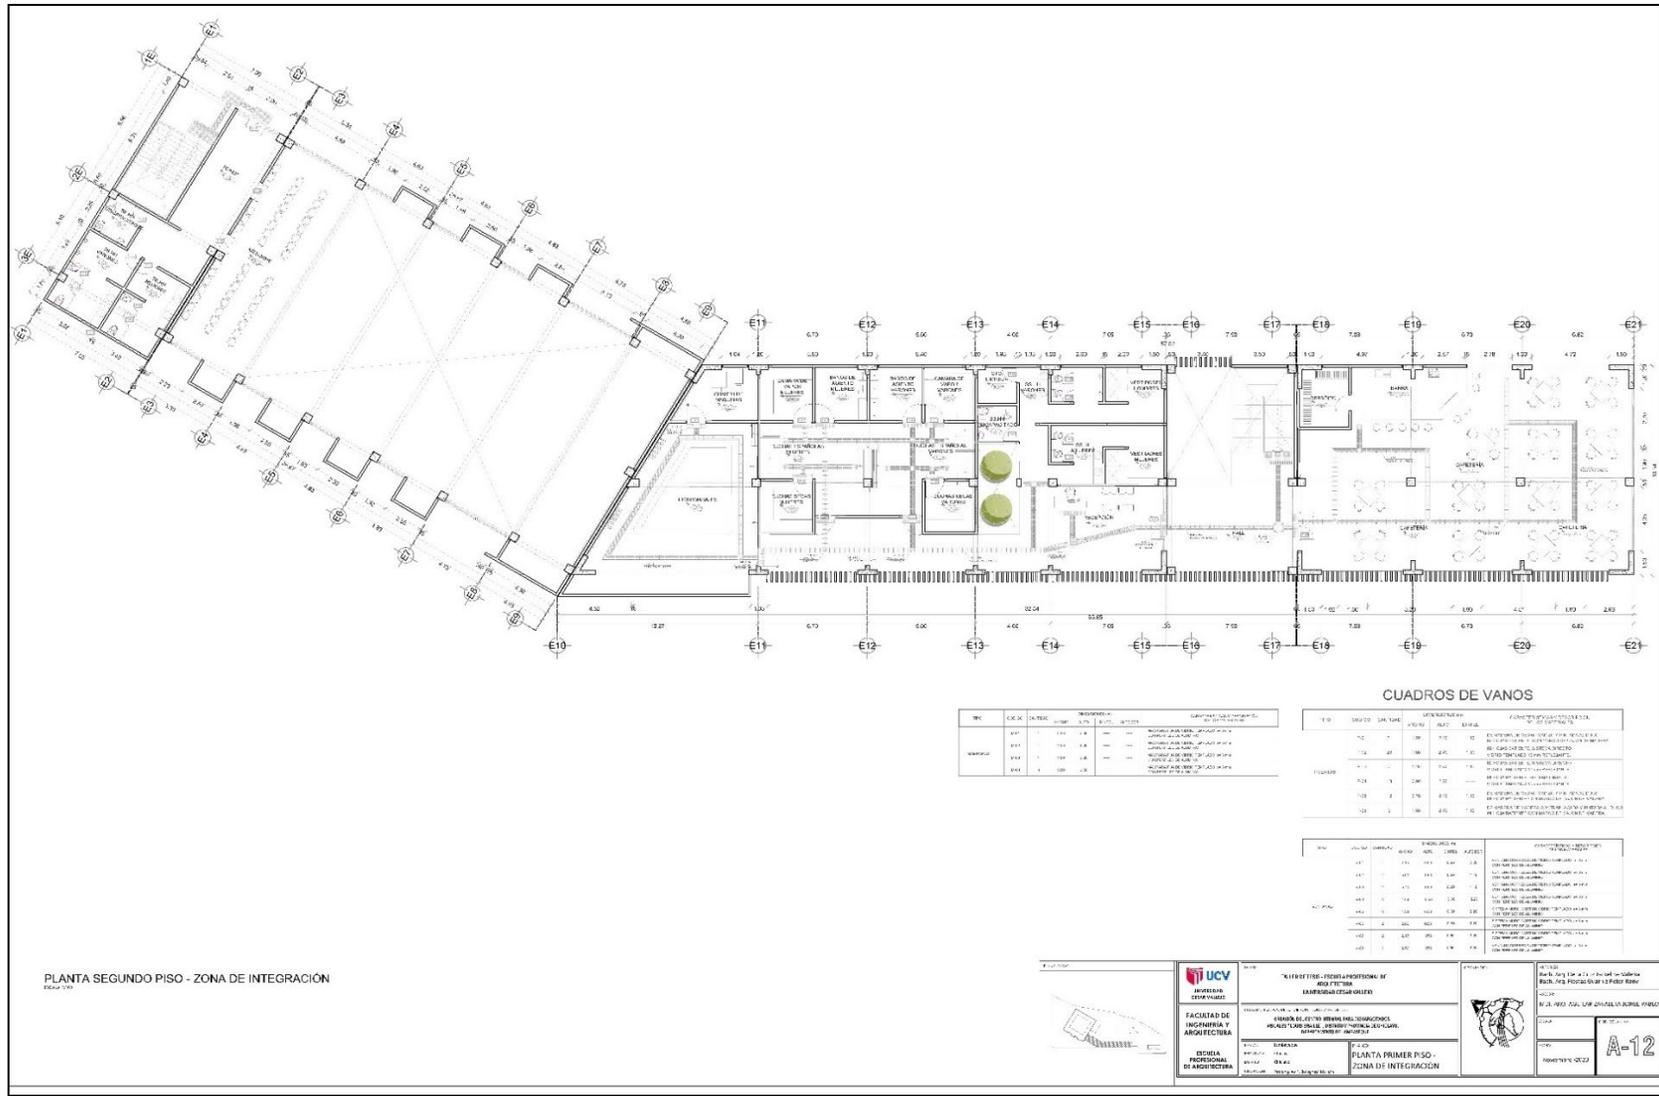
Planta segundo nivel-zona de integración. Fuente: Elaboración propia.
